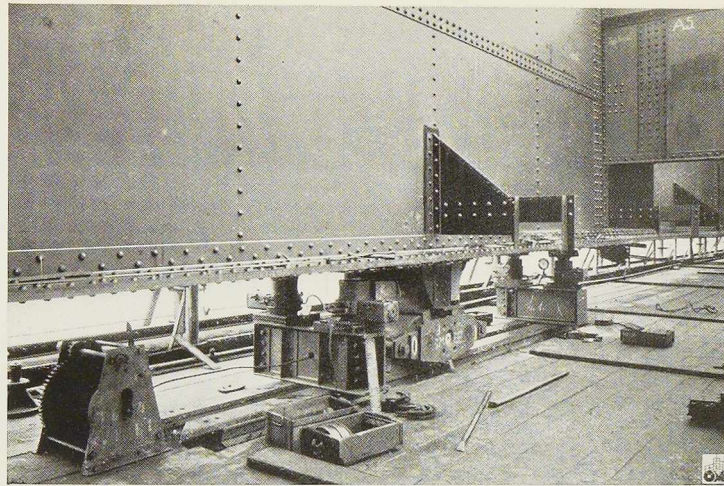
Avancement des poutres de rigidité au moyen d'un chariot.
